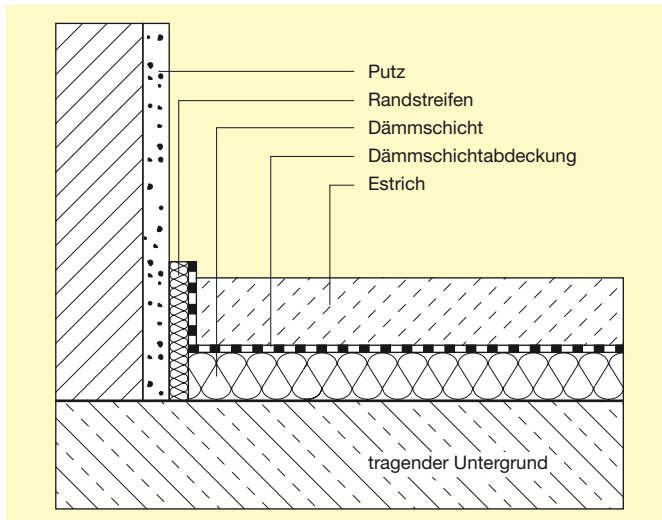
Estrich auf Dämmschicht, Wandanschluss
